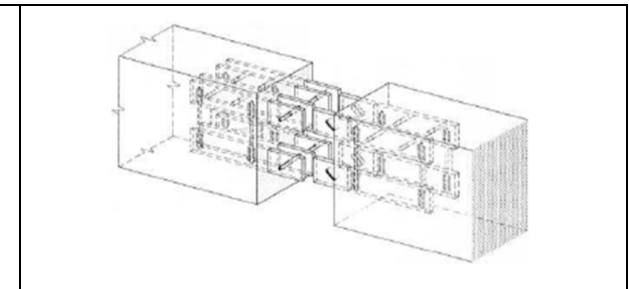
Ligação por chapas metálicas aparafusadas e betonagem *in situ* (Stupré, 1981)
